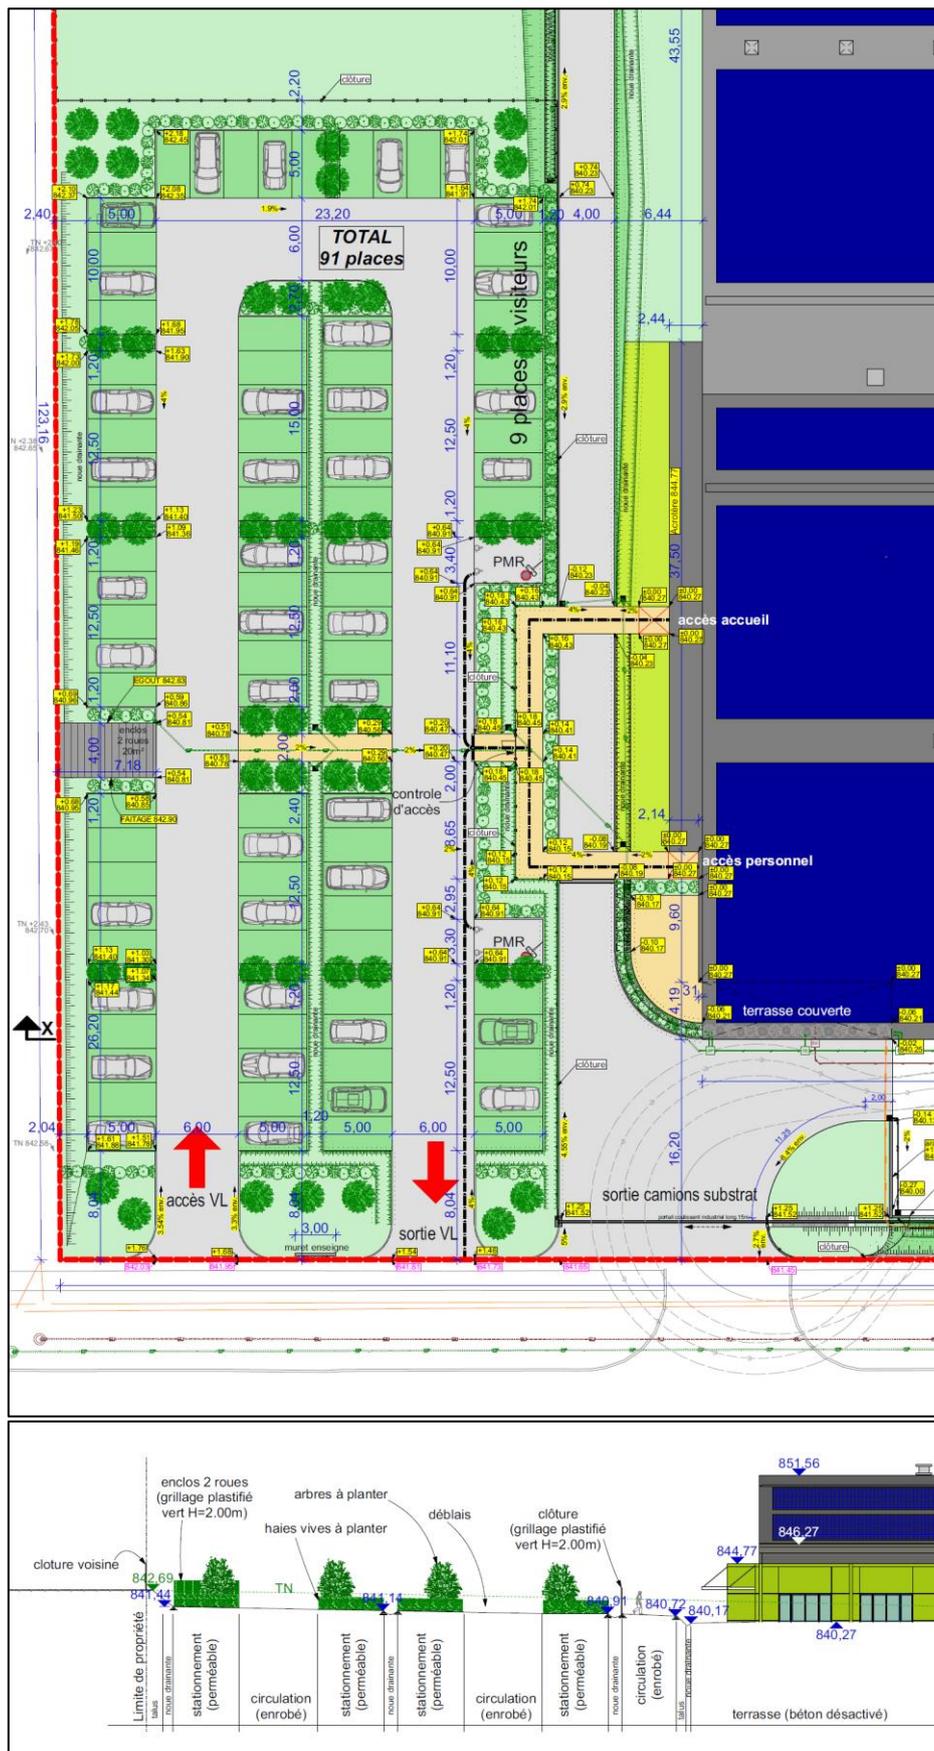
Détail de l'aménagement du parking au Sud-Ouest du site (source : Tricot Architecte)
